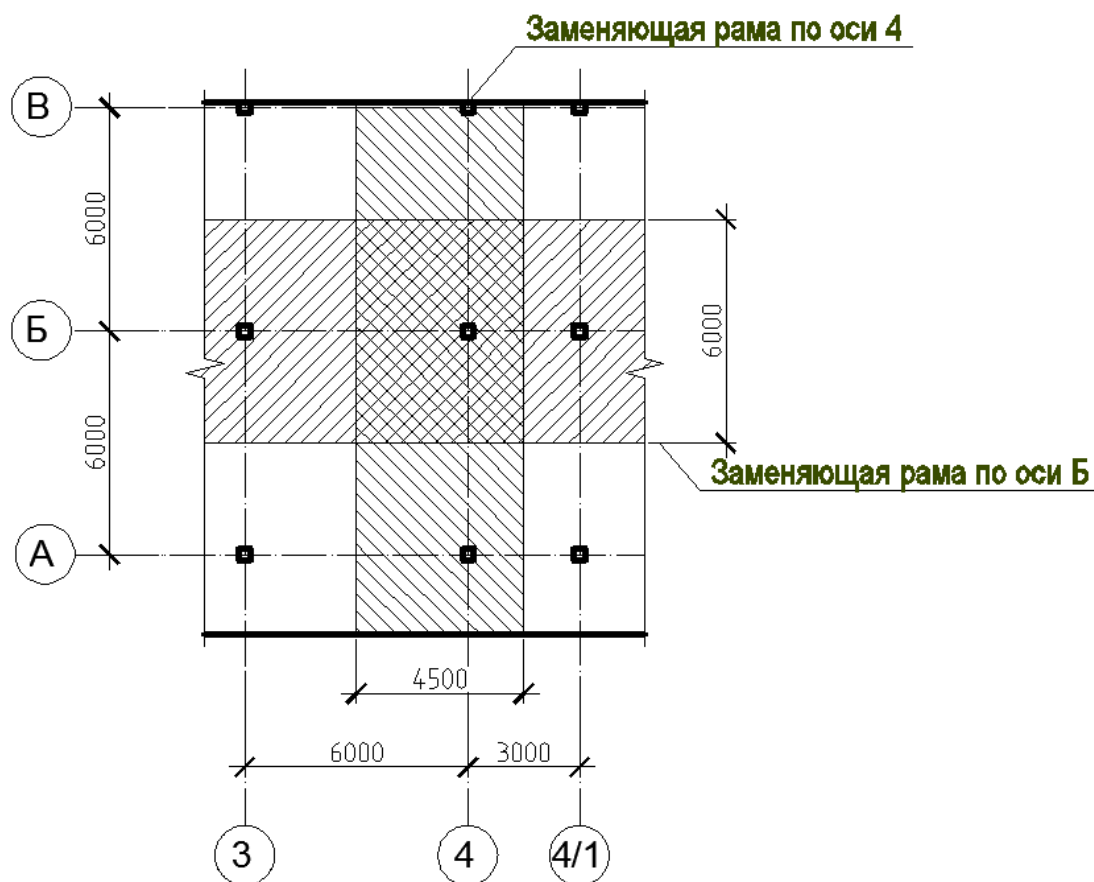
Схема заменяющих рам для расчета перекрытий
